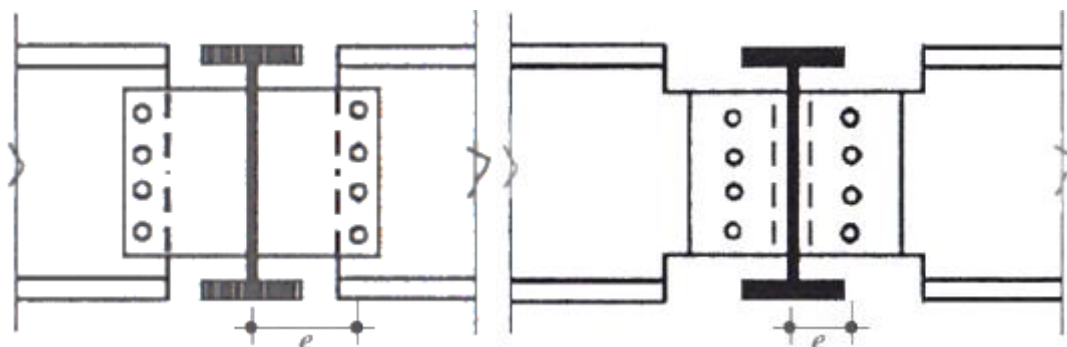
Vigas ligadas pela alma por meio de chapas gousset, (Silva & Santiago, 2003)
